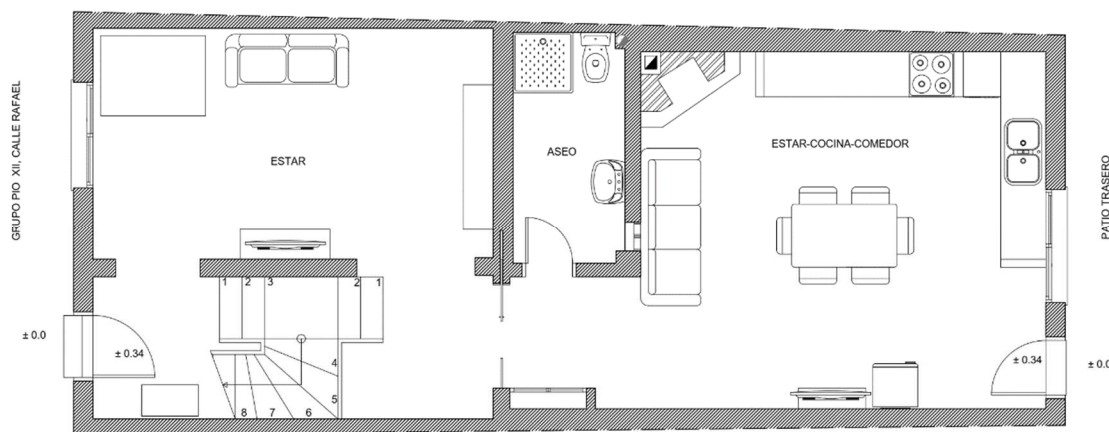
Planta baja AutoCAD. Fuente propia programa AutoCAD
